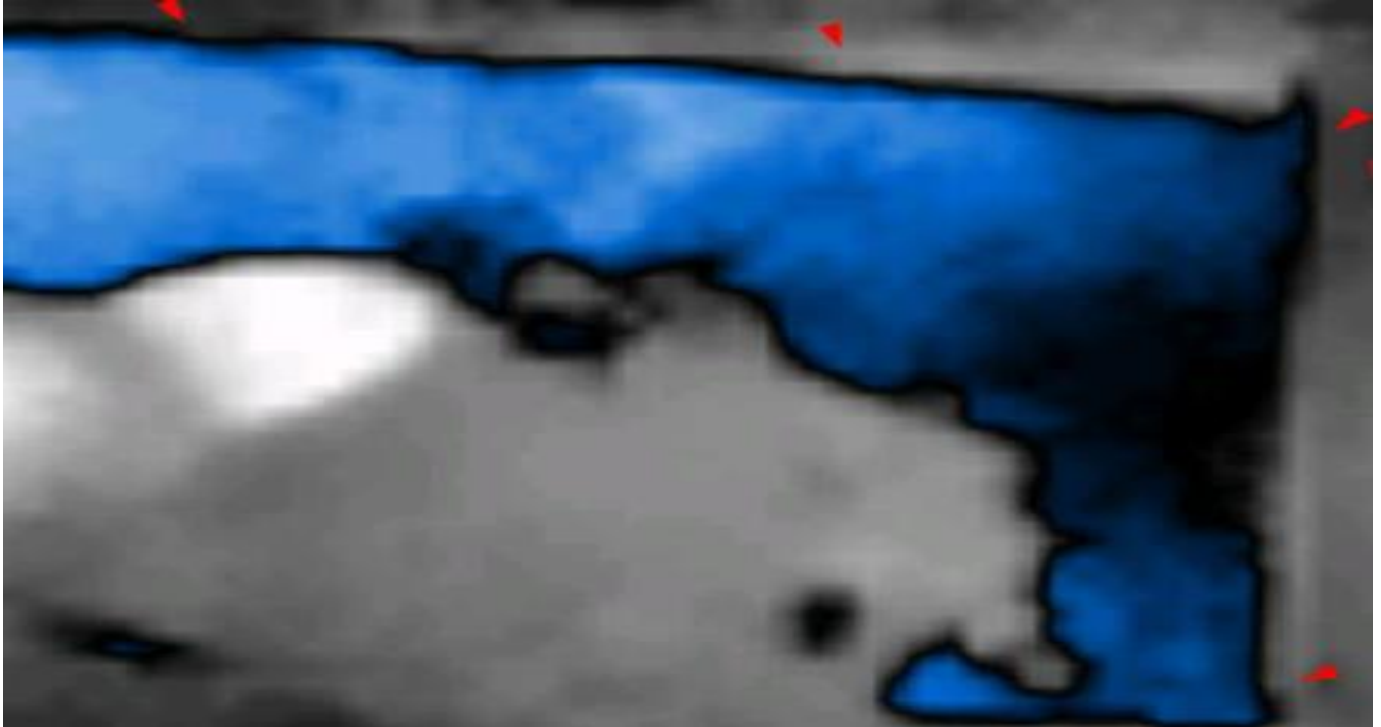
Vista da face da fachada do 3º andar com reparos construtivo
